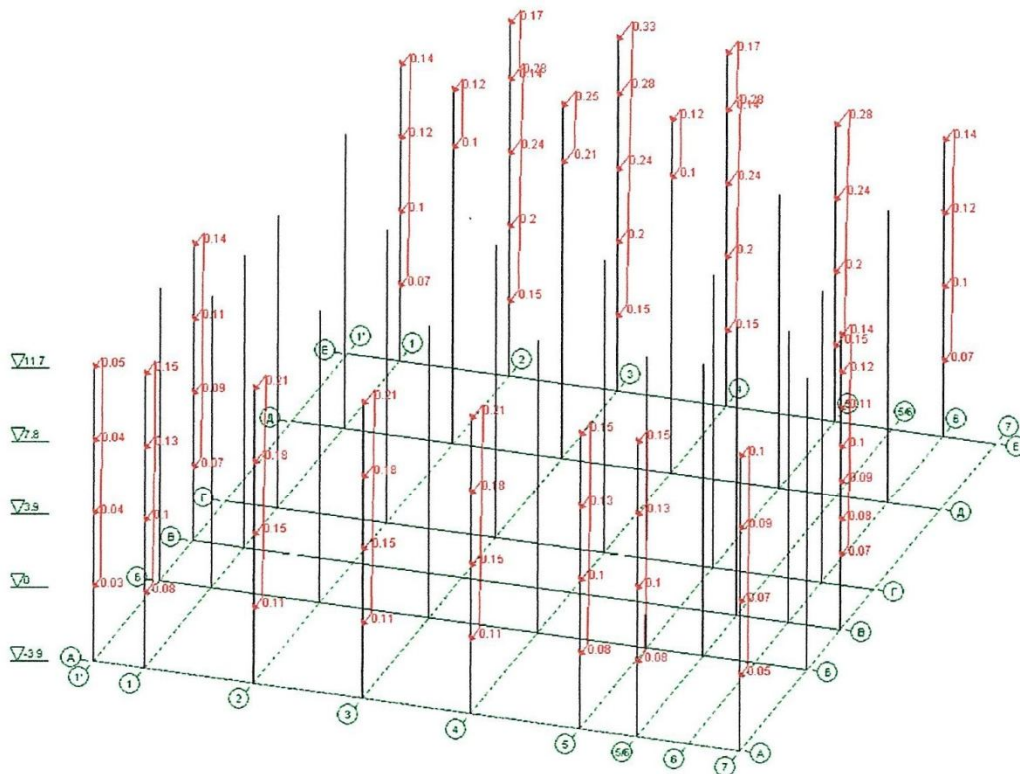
Схема завантаження 9 – навантаження на колони від вітру
